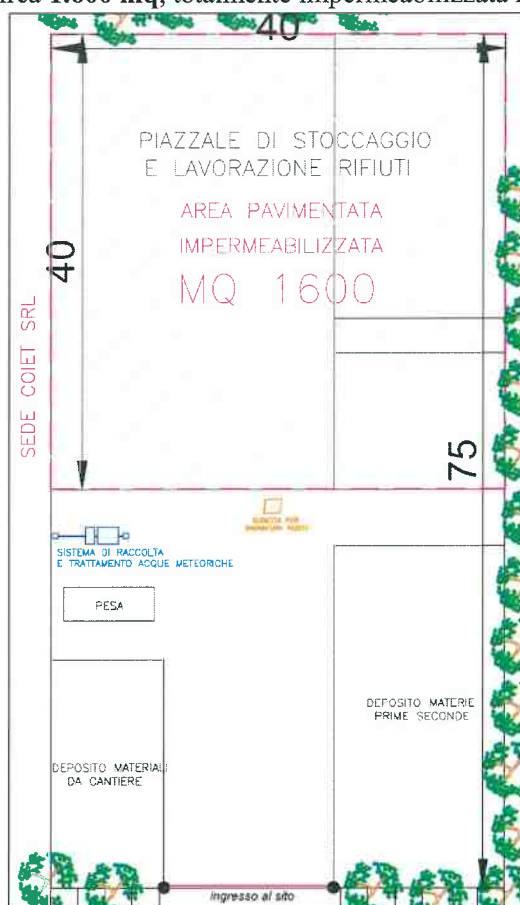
Planimetria generale impianto (da Tav. 13 allegata allo SPA)
